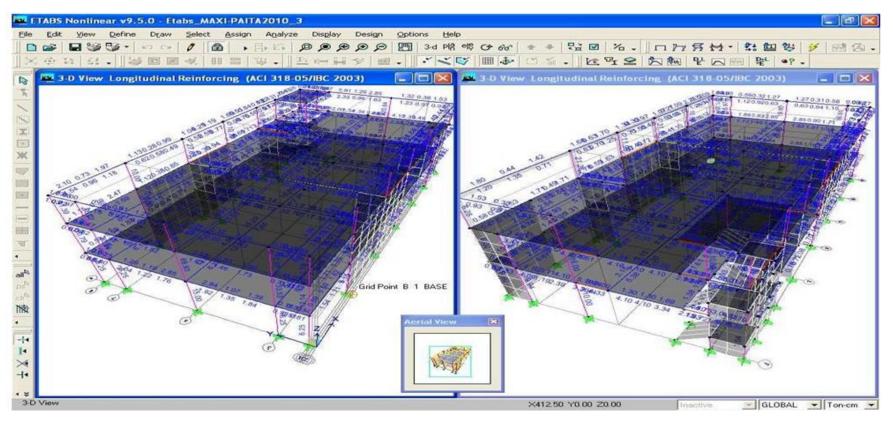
Diseño de refuerzo longitudinal, en vigas y columnas.
